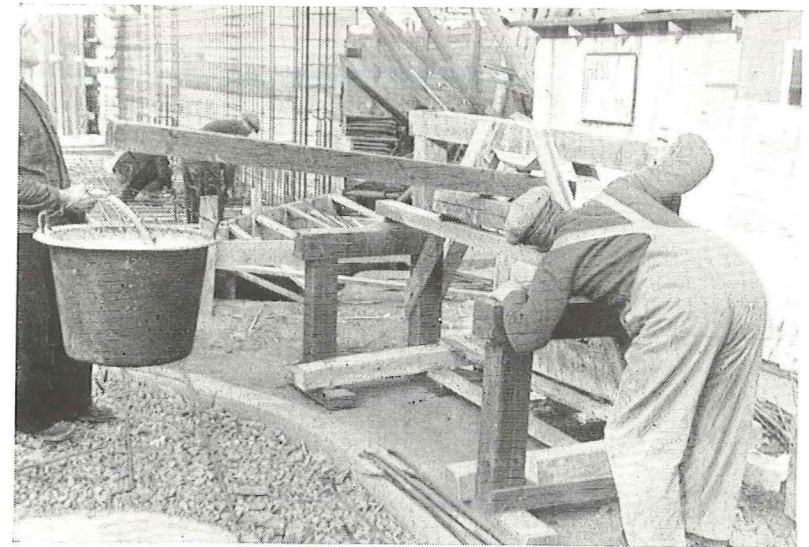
Brudforsøg med betonprobebjælke på en byggeplads.
